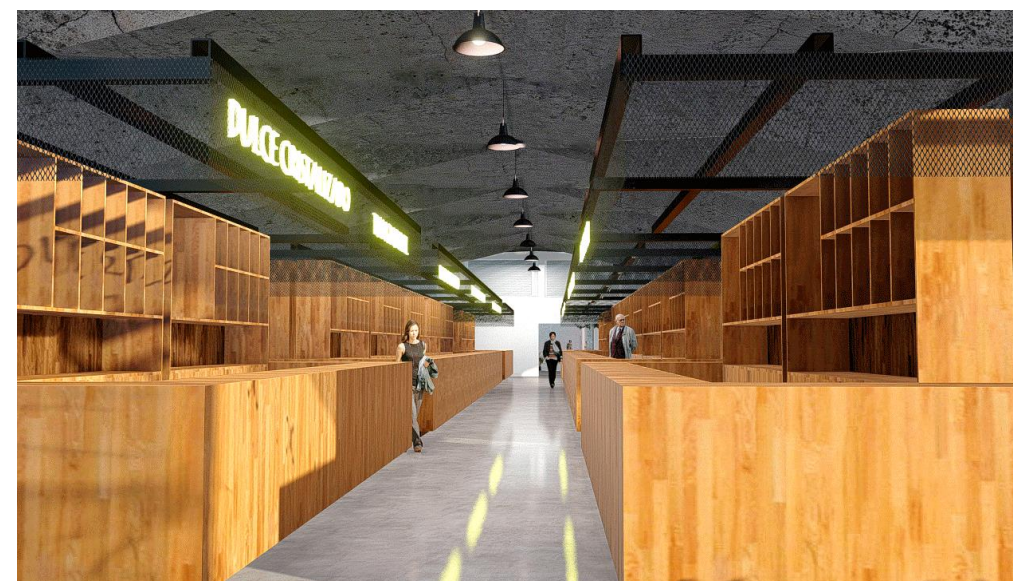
Perspectiva-proyecto en interior de Construcción "A" con vista hacia construcción "B" (Elaboración propia).
